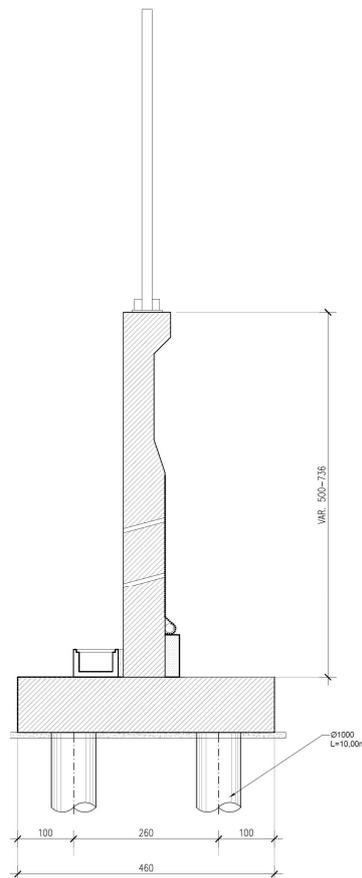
Muro di scavalco in c.a. su fondazioni profonde – Sezione tipo
